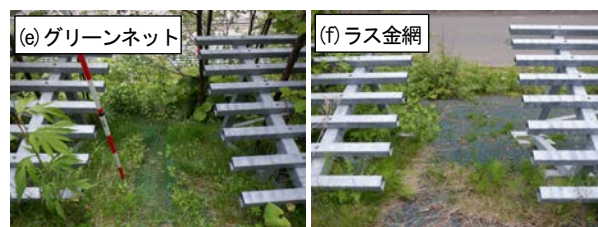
(e-f) 雪崩予防柵間の対策工施工状況
